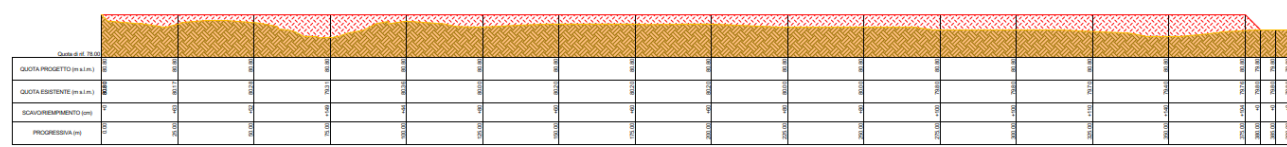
Profilo longitudinale di progetto della difesa di sponda. Estratto della tavola PF.0.0.8.PRG.GE.S.Z.0.0.2.A.
